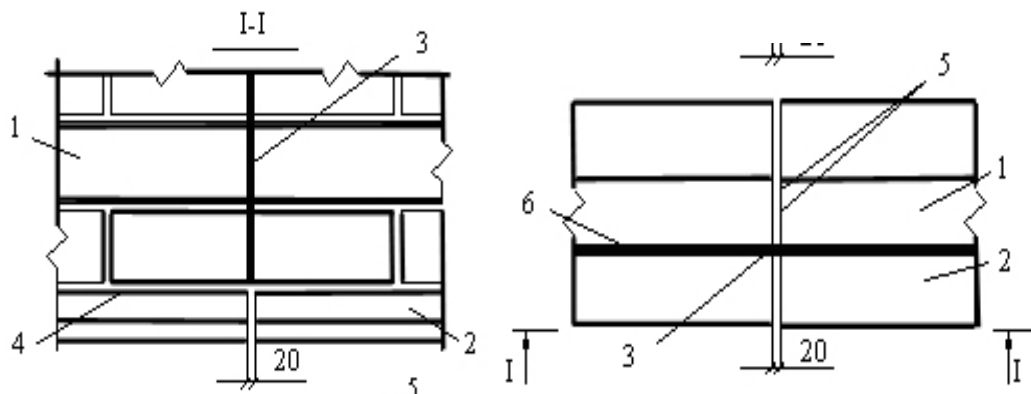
Деформаційний шов: 1 – стінові блоки; 2 – фундаментні плити; 3 – ущільнювальна мастика; 4 – цементний розчин складу 1:2; 5 – антисептовані дошки, обгорнені толем; 6 – фарбувальна гідроізоляція
